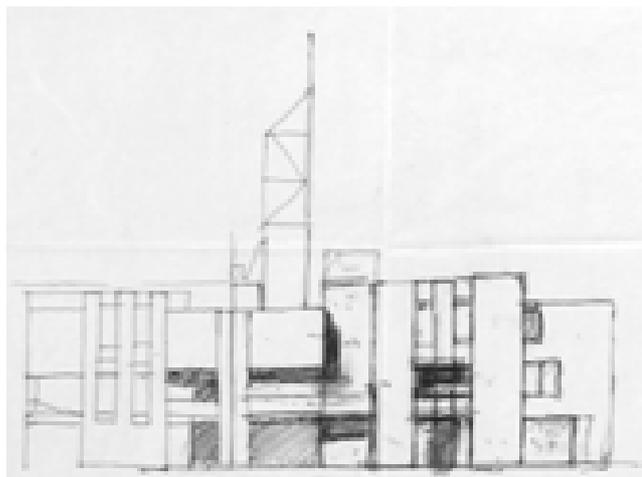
SX, Schizzo del prospetto con campanile –03/06/1996 (AABS-1996.524)
